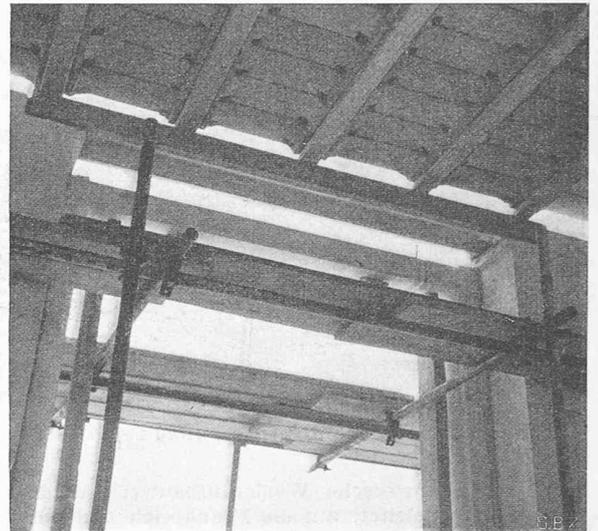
Boden aus Spannbeton-Elementen mit Löchern für die Deckenaufhängung
